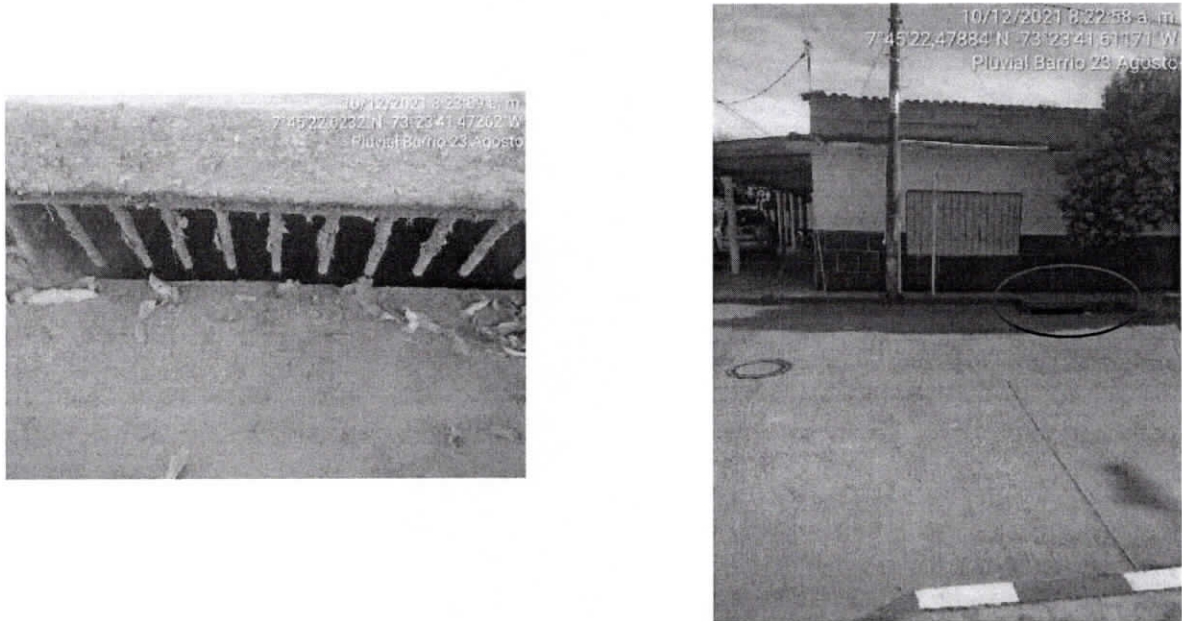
Alcantarillado Pluvial Crr 9 con calle 3, barrio 23 de Agosto.
